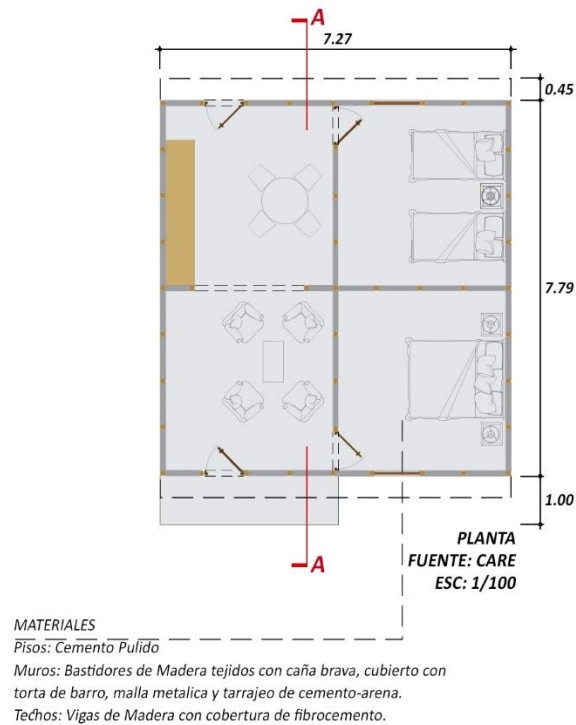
Planta del módulo de vivienda en Pampa Mendoza
